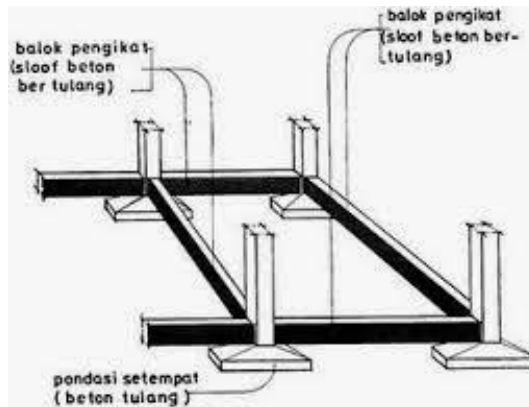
Bentuk-Bentuk Pondasi Setempat
